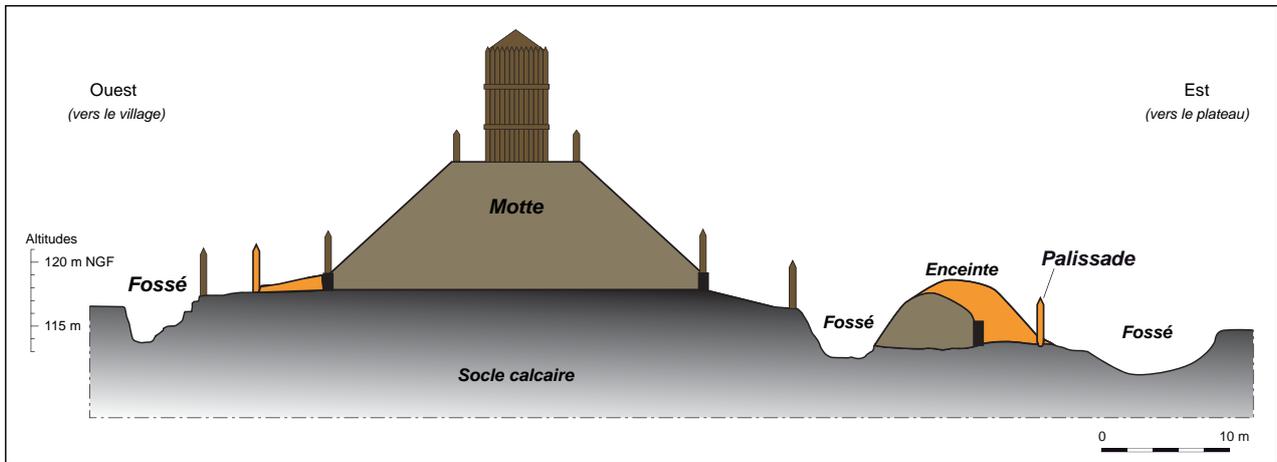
Coupe restituée de la motte (2 premiers états de construction).
